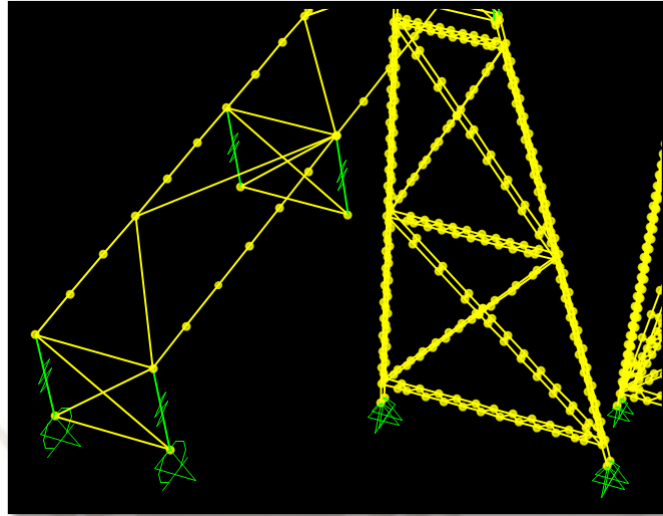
Modelo en CSI bridge, con vista “Standard” de secciones dibujadas.
